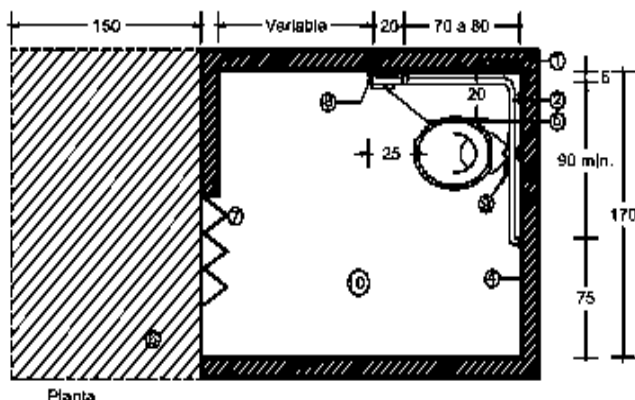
Dimensiones mínimas en sanitarios (Planta) / Fuente: manual técnico de accesibilidad SEDUVI, P.102
